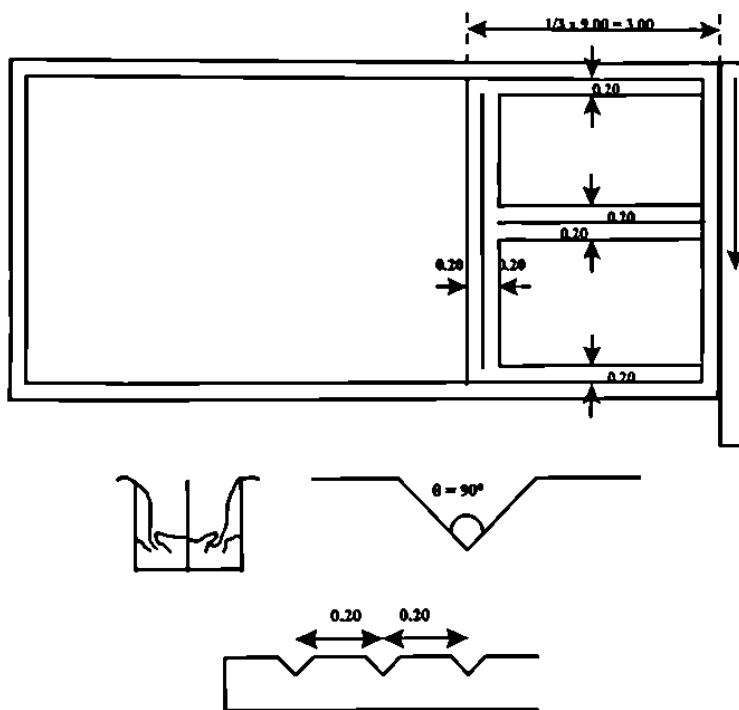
Planta de canaleta y tipo de vertedores.
